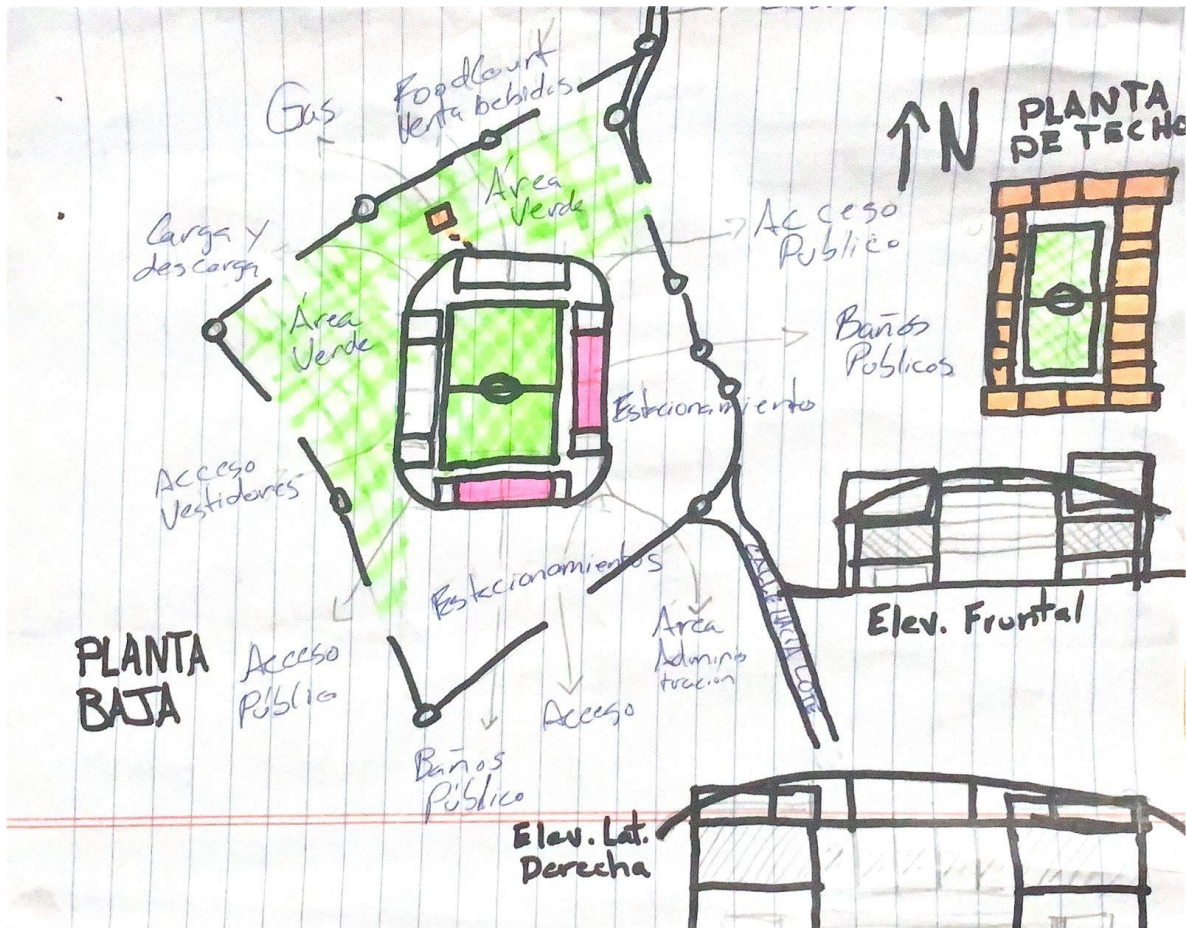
Esquema de distribución de espacios, fachadas y planta de techo.
